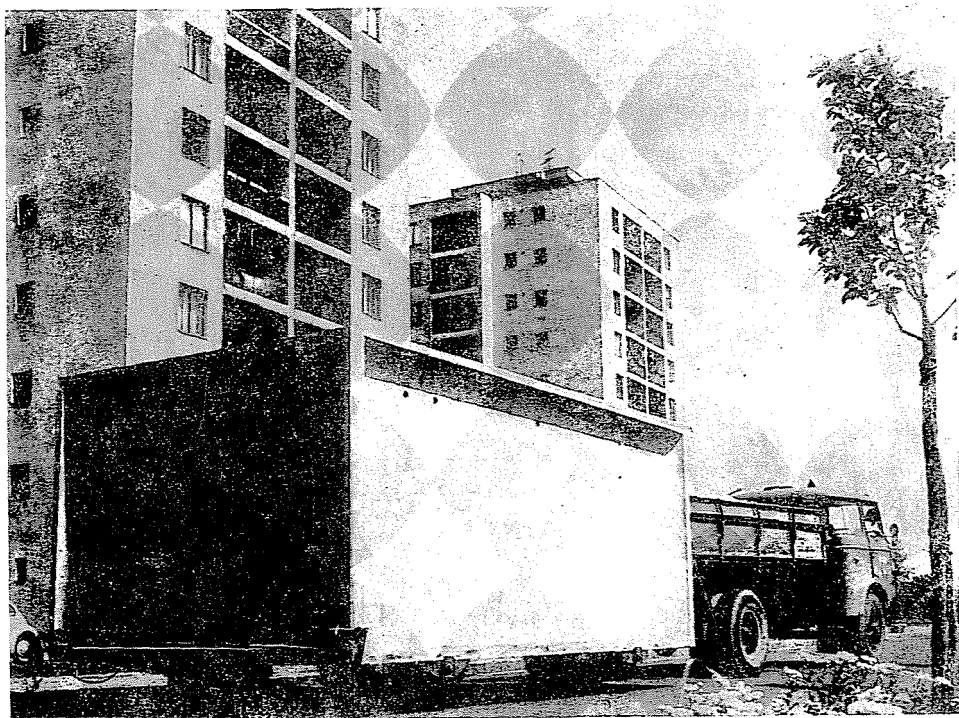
Transport einer Stahlbeton-Raumzellengarage
